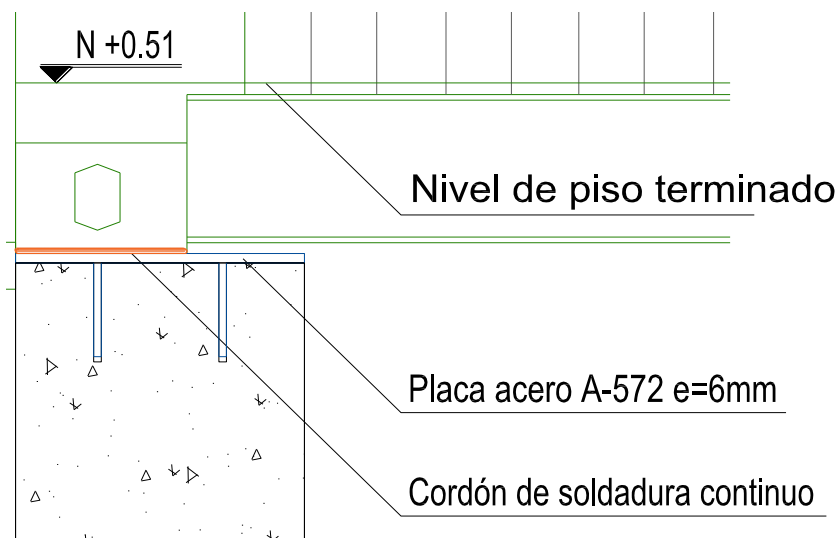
Soldadura entre la placa de anclaje y el contenedor.
